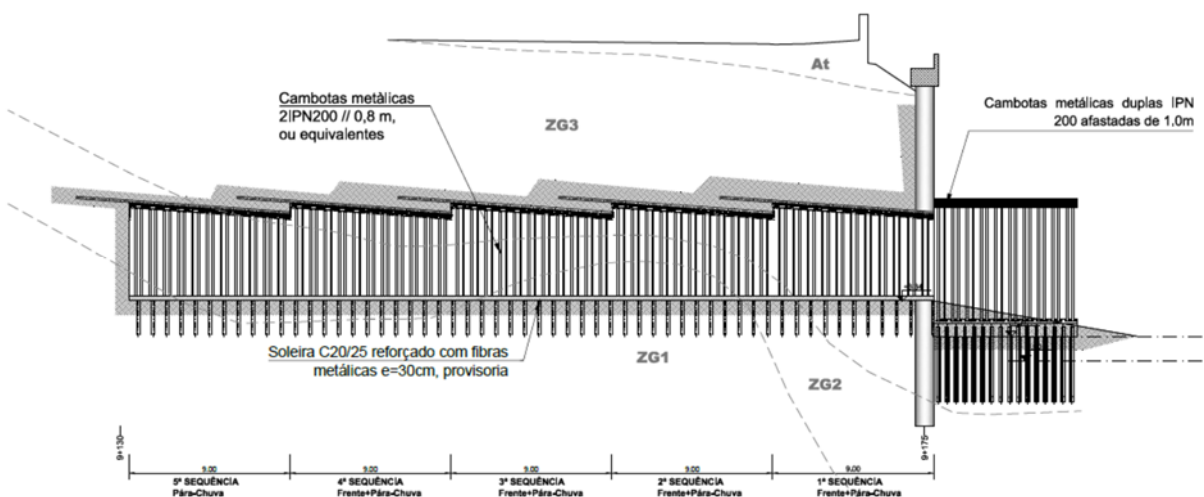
Fase 3 – escavação 36 m da calote superior em ZG3emb
